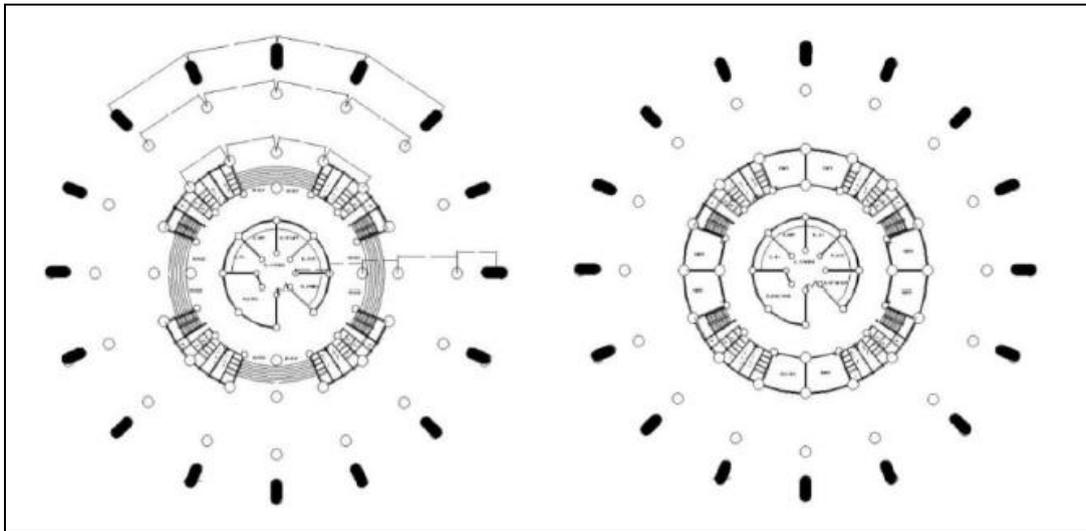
Site plan kawasan *futsal center* di Pontianak
